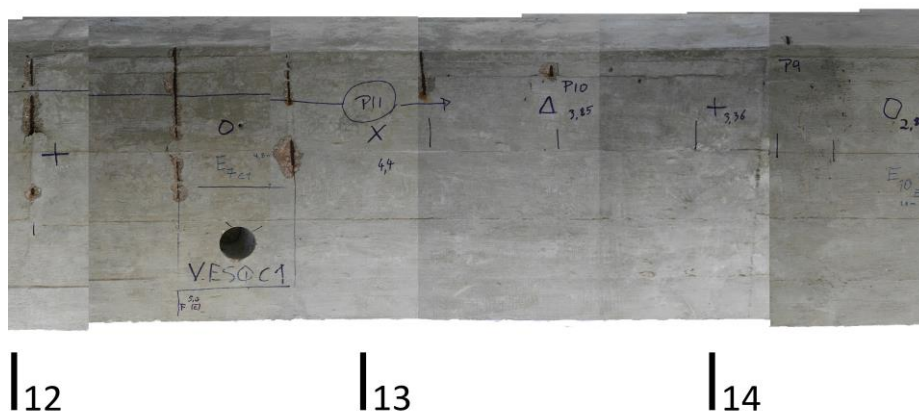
Foto da viga esquerda entre os 12 e 14,5 metros
